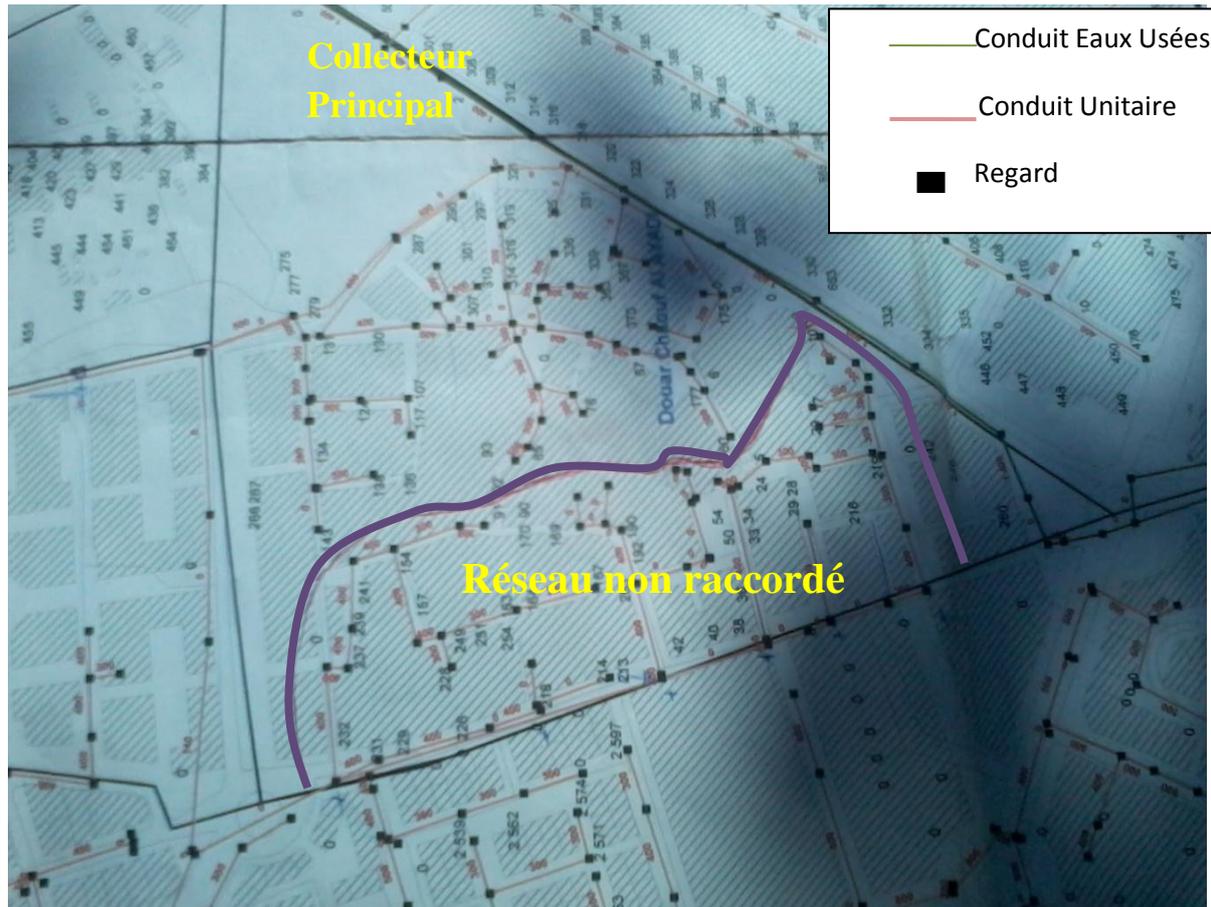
Plan du réseau d'assainissement du secteur Al Azzouzia
